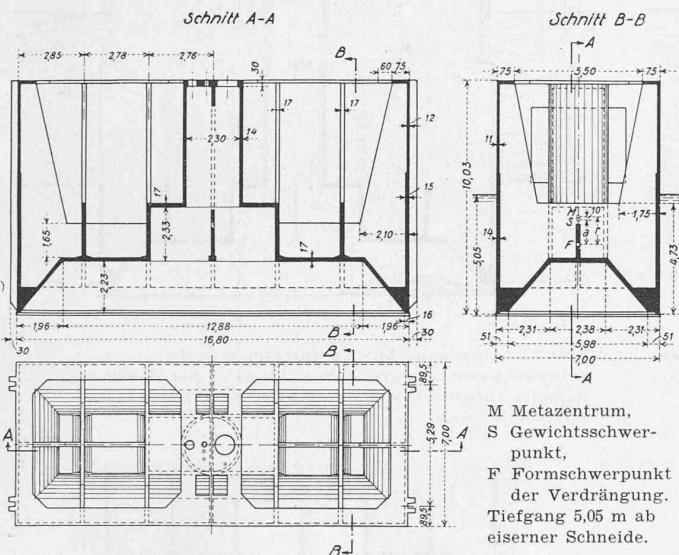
Draufsicht und Schnitte der Eisenbetonensenkosten 23 bis 38.
